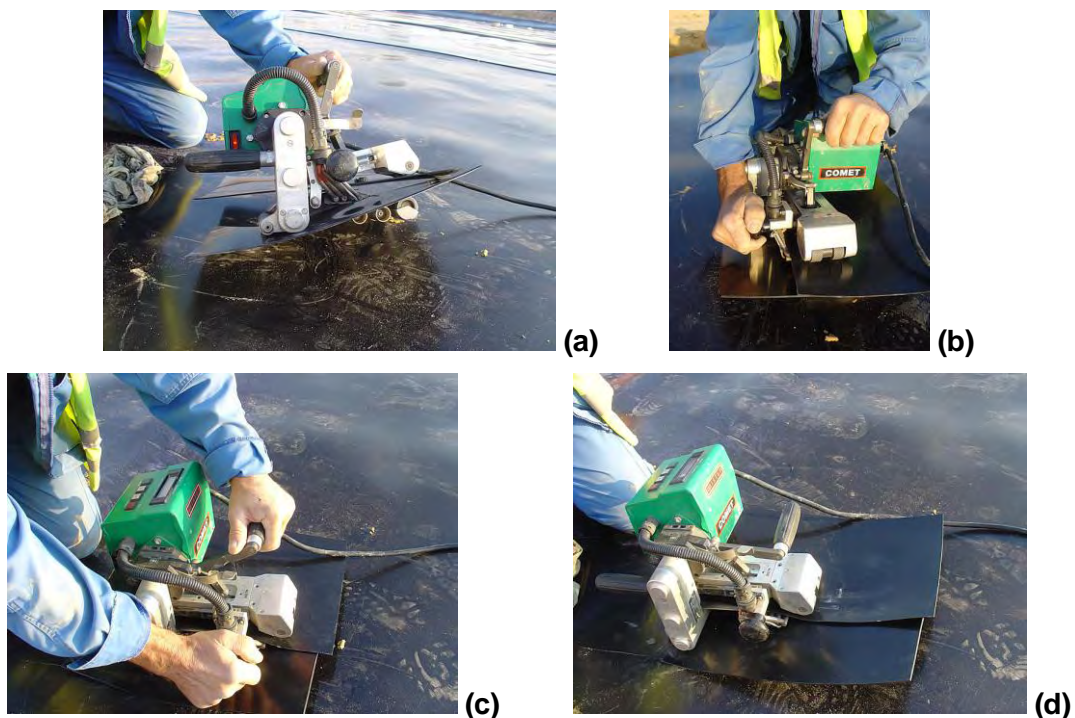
Demonstração de execução de soldadura dupla.
